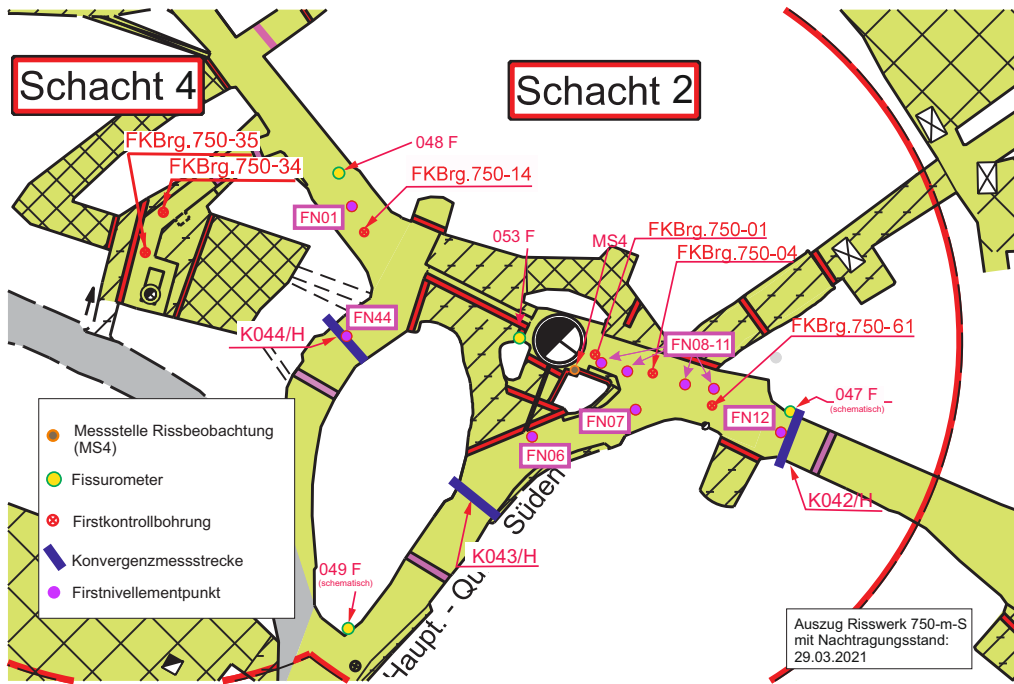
Grundrissausschnitt der 750-m-Sohle mit Messbohrungen und -systemen
